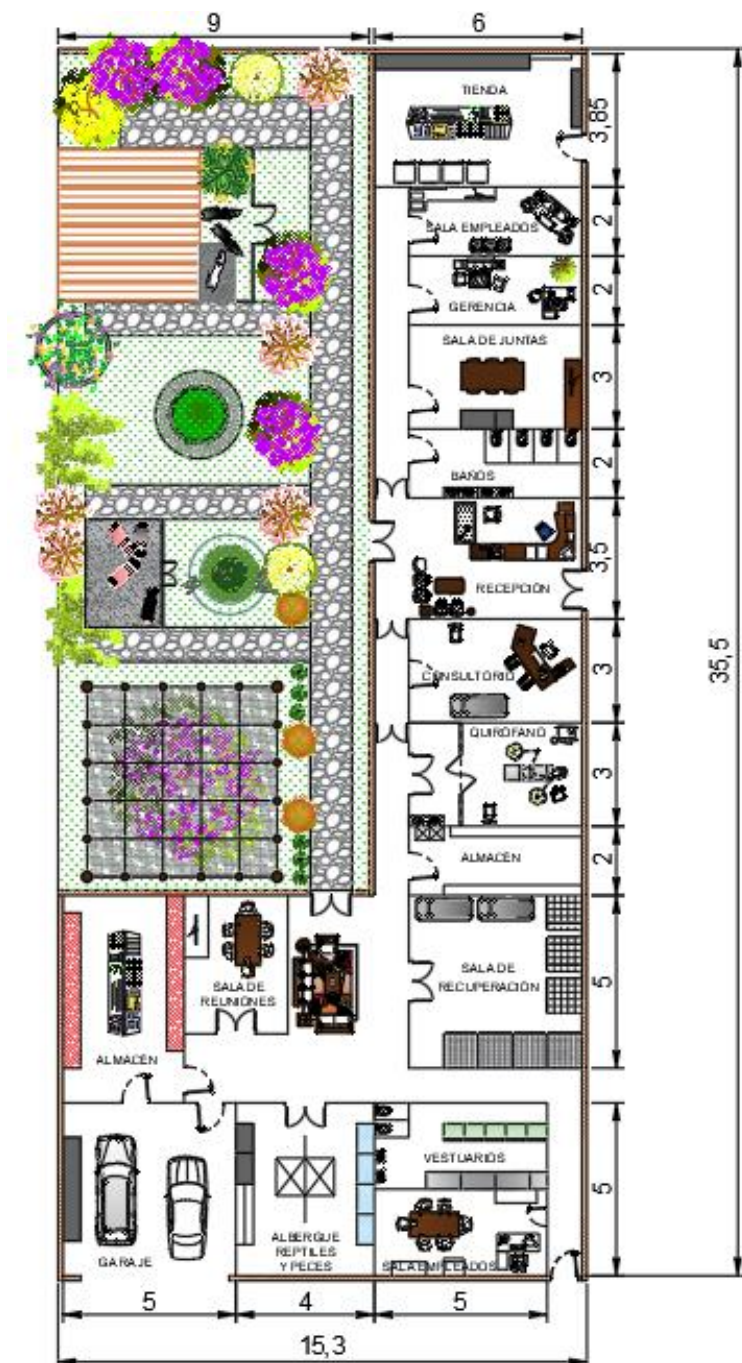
Diseño arquitectónico en planta y localización de muros. Fuente: Plano CENCAB
